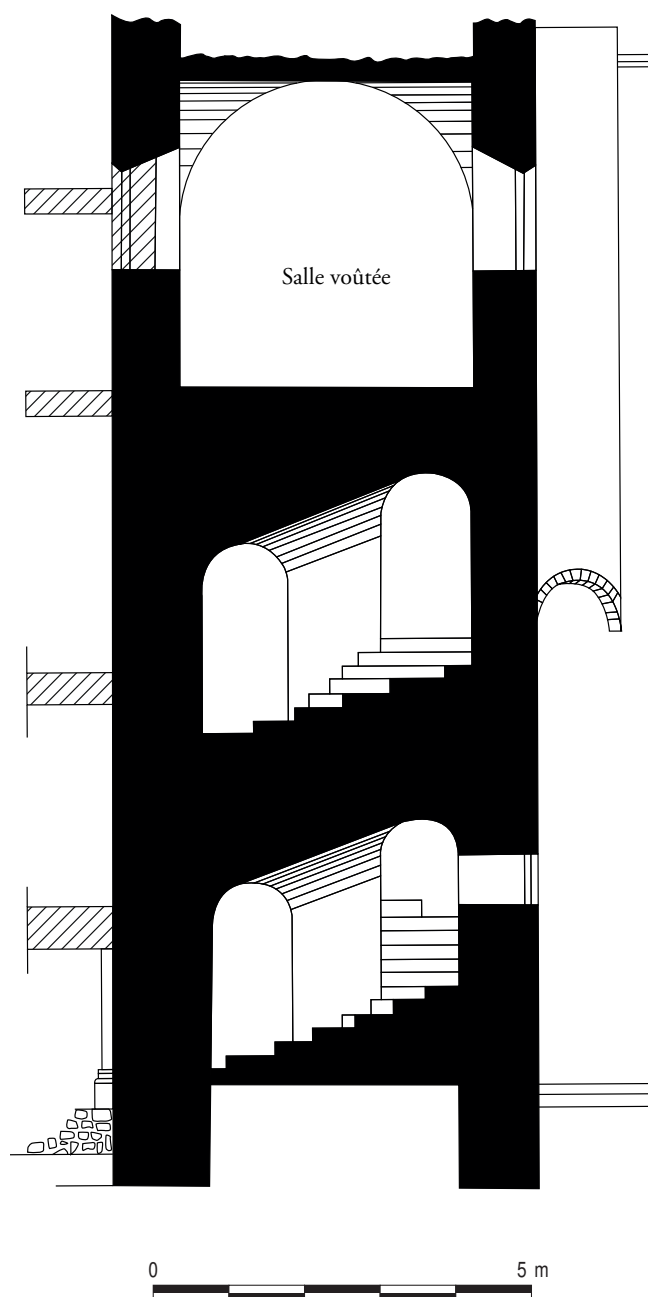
Coupe de la tour d'escalier (relevé Pierre Simonin).
